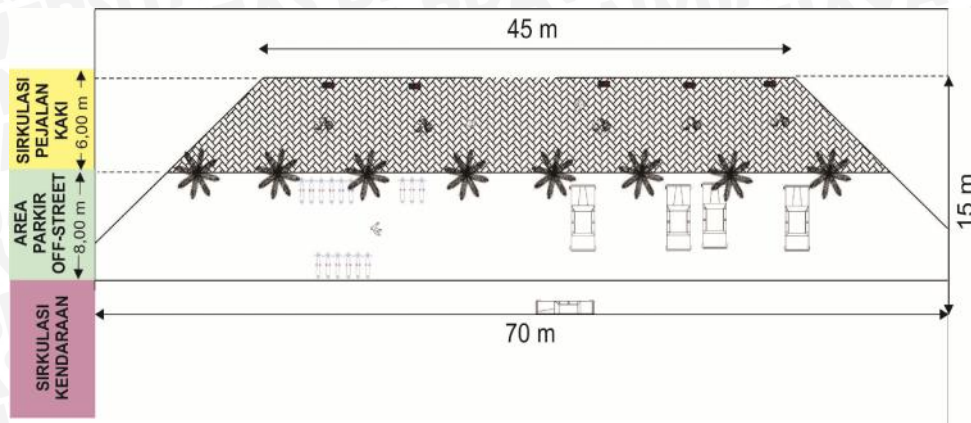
Penampang Parkir *On-Street* Jalan KH. Wahid Haysim
